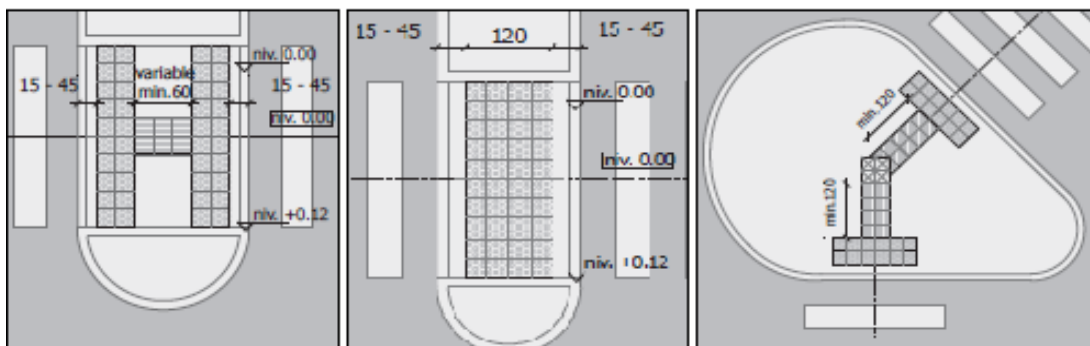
Quelques exemples de disposition des dalles de repérage cas particulier des îlots de refuge.
